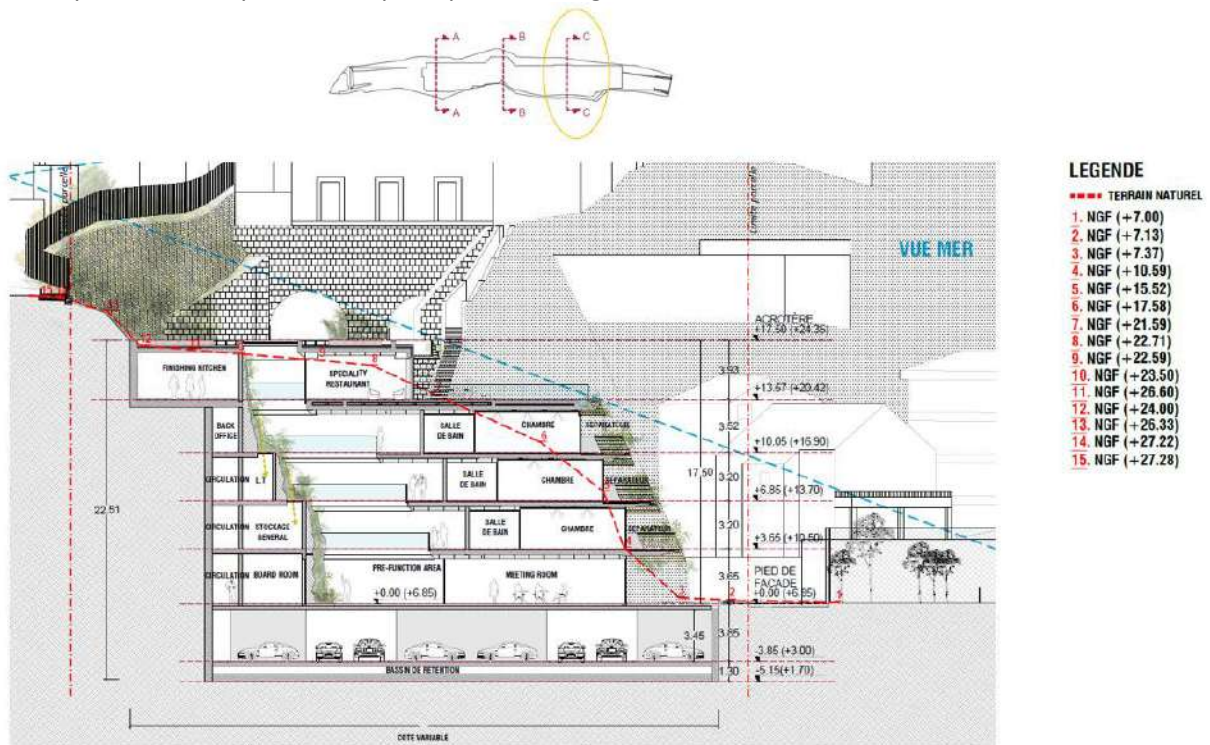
Coupe C-C du projet (source : dossier de plans [5])
